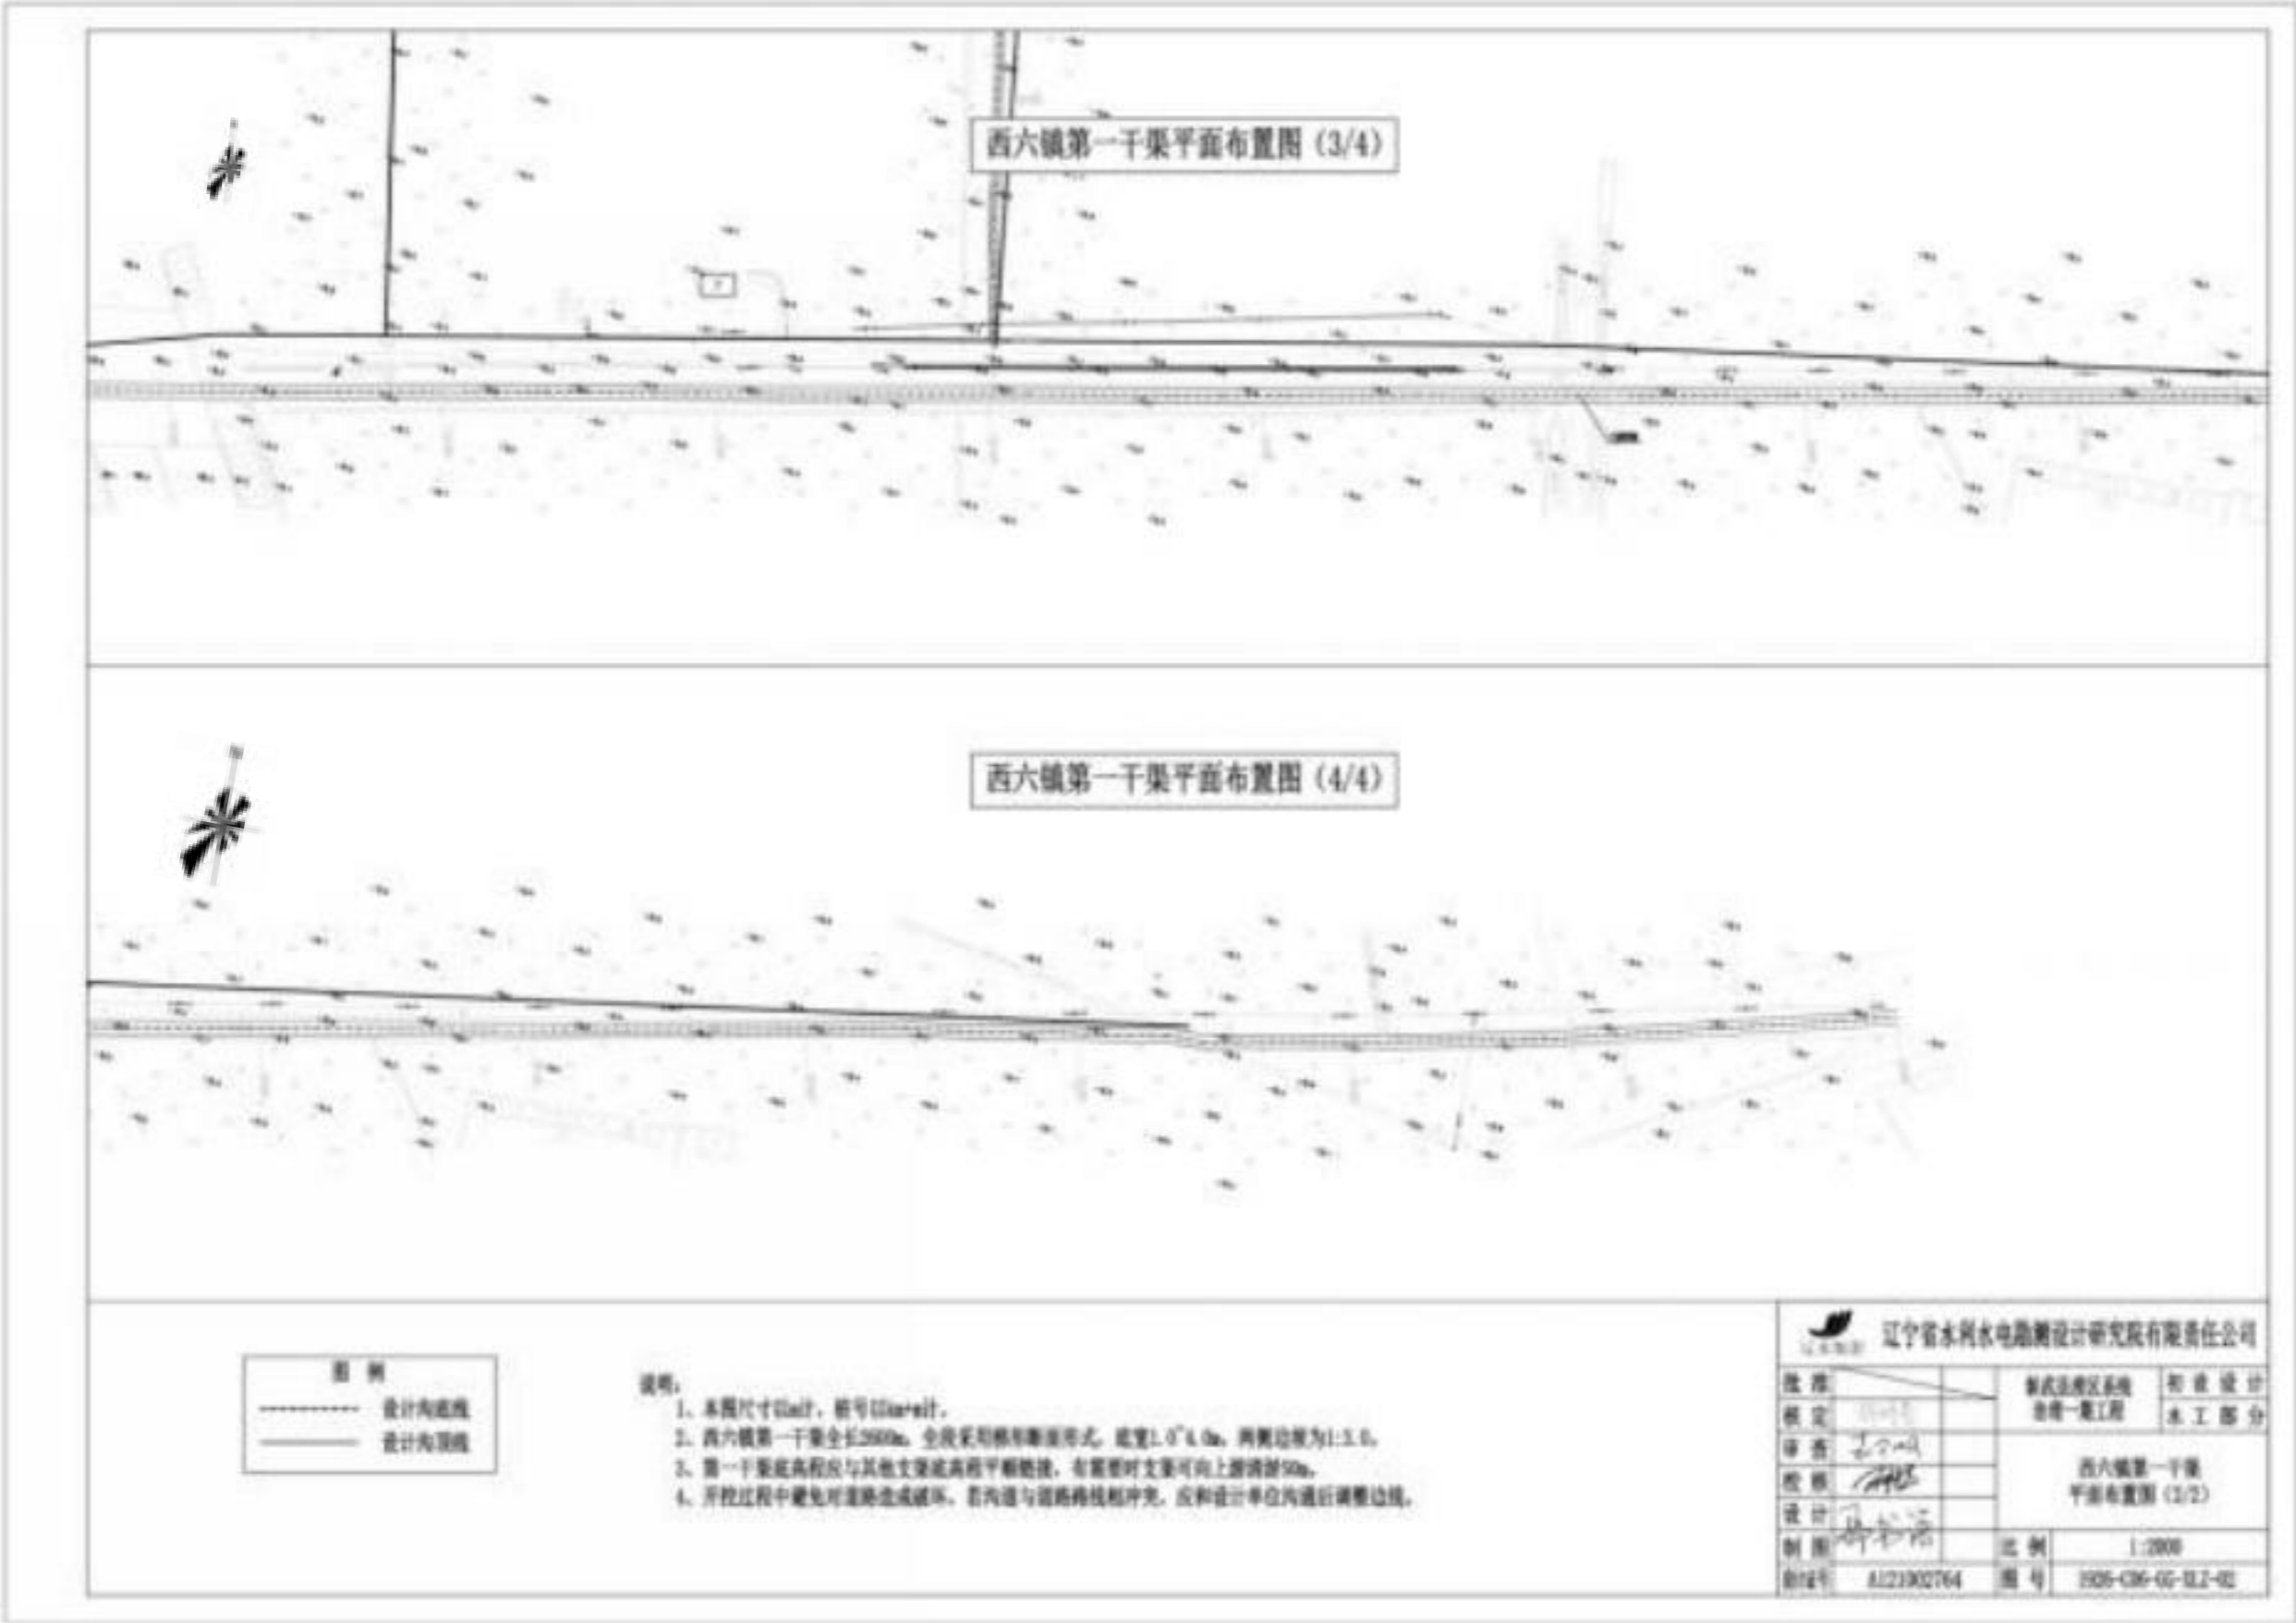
(2) 西六家子镇第一干渠平面布置图
